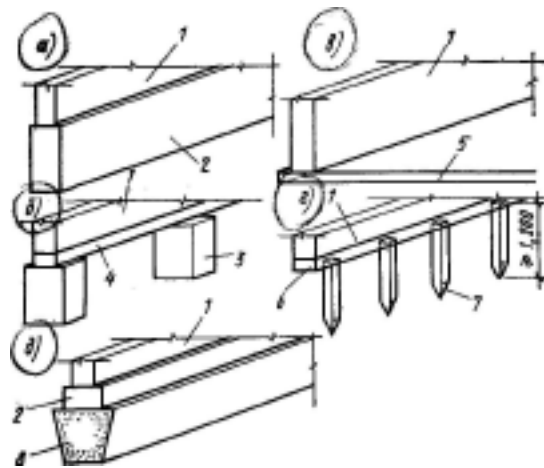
Рис. IV.О Конструктивные схемы фундаментов мвьяэтажных жилых зданий:
